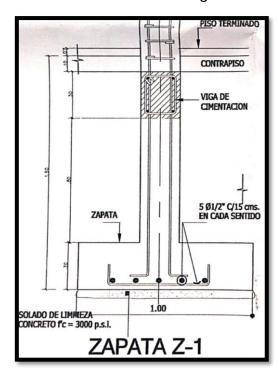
y 19 Detalle de Zapata y Viga de Arrastre
